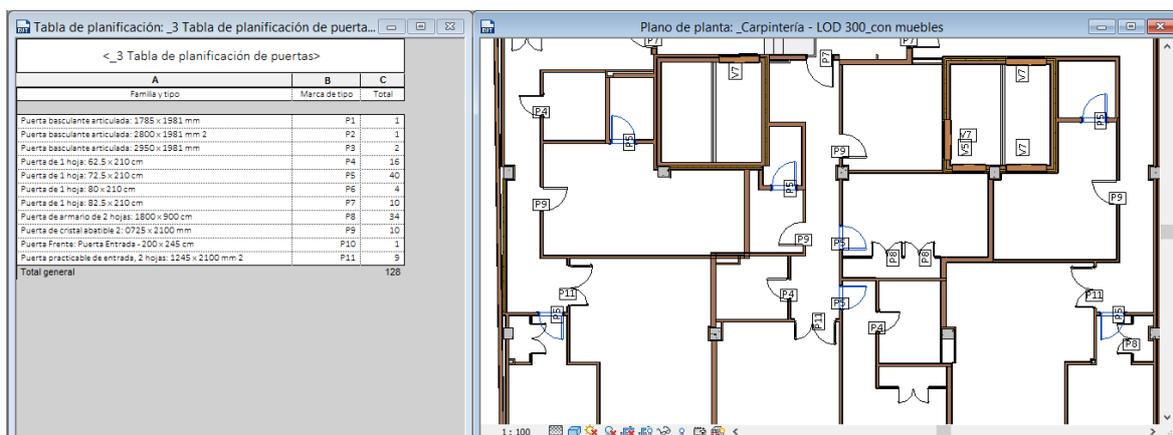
Plano de carpintería y Tabla de Planificación de Puertas, 2014.
